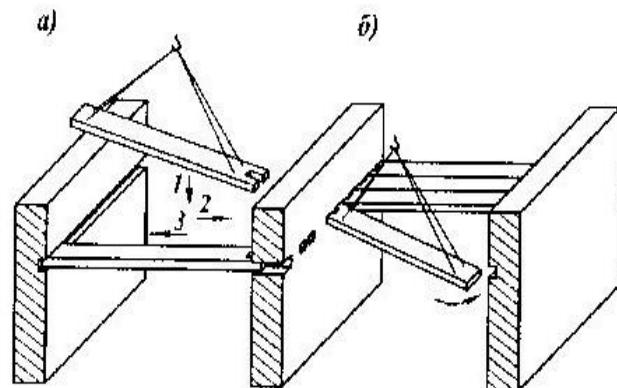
Монтаж сборных элементов перекрытий: а – подача элементов в наклонном положении; б – монтаж с поворотом в горизонтальной плоскости; 1, 2, 3 – этапы работы
